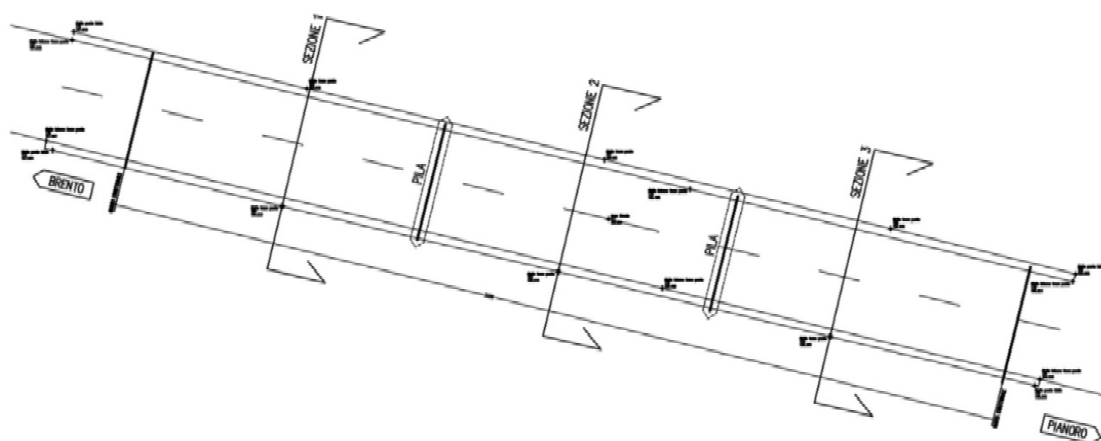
rilievo Piacentini Ingegneri, pianta
